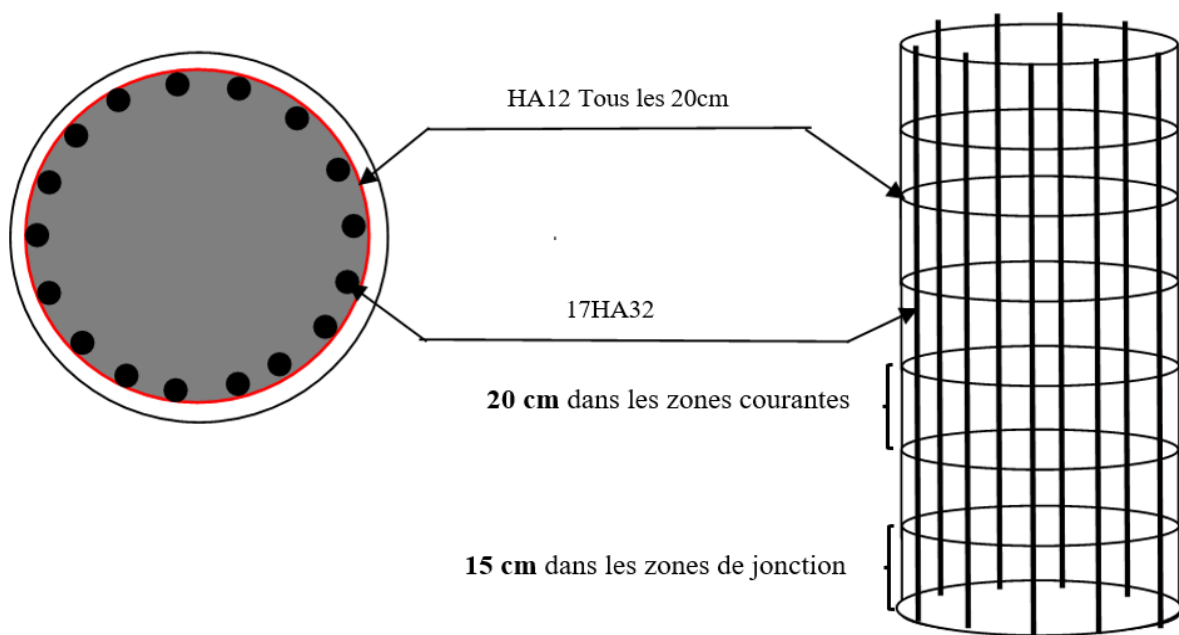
FERRAILAGE DES PIEUX
